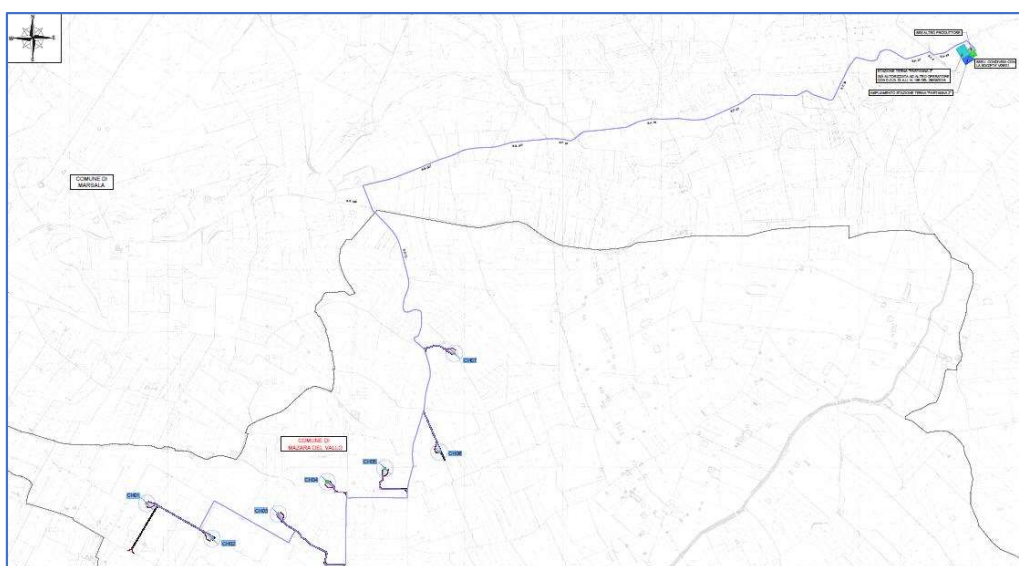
stralcio Elaborato "Layout di progetto su planimetria CTR
